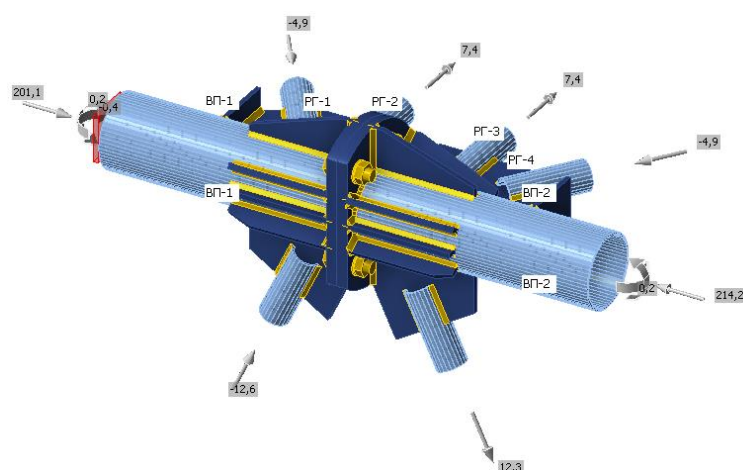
Монтажний стик верхнього поясу просторового блоку ферми
